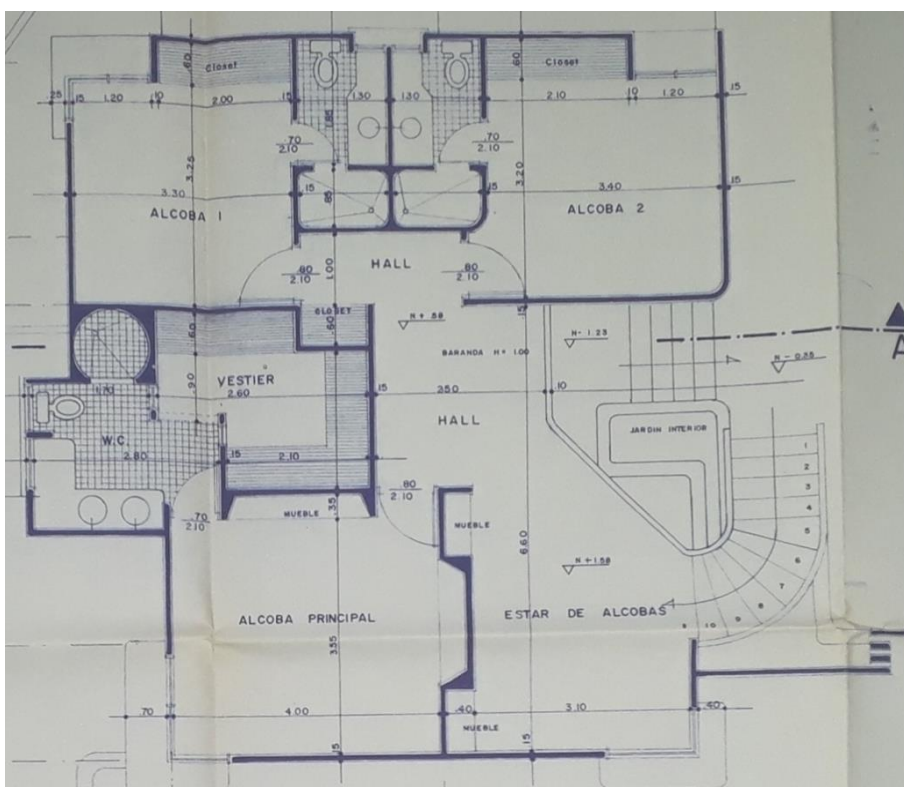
Planta arquitectónica 2 piso vivienda unifamiliar (1983).
